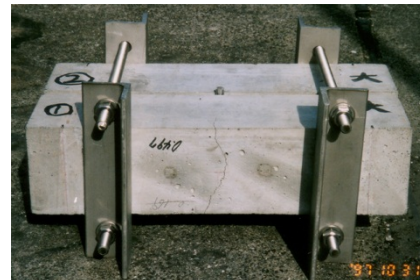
暴露供試体Bのひび割れ制御状況
